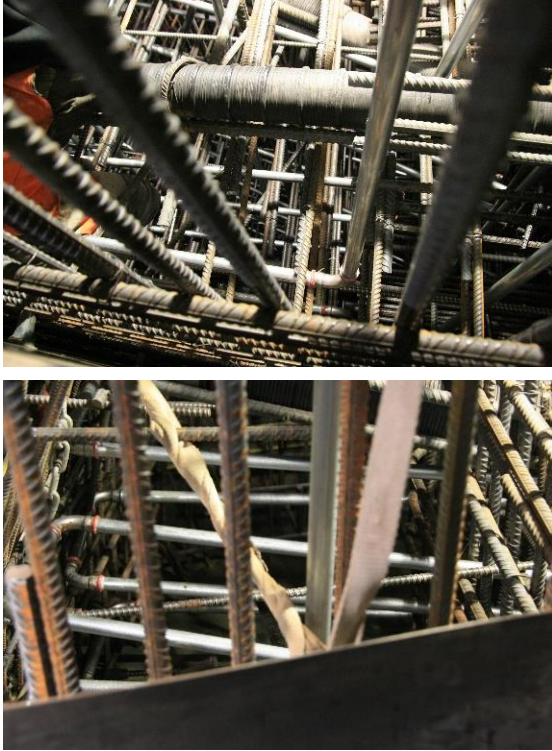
Bewehrungskorb mit Kühlleitungen (glatt und silberfarben) eines Deckelabschnittes mit Vorspannleerrohren.
